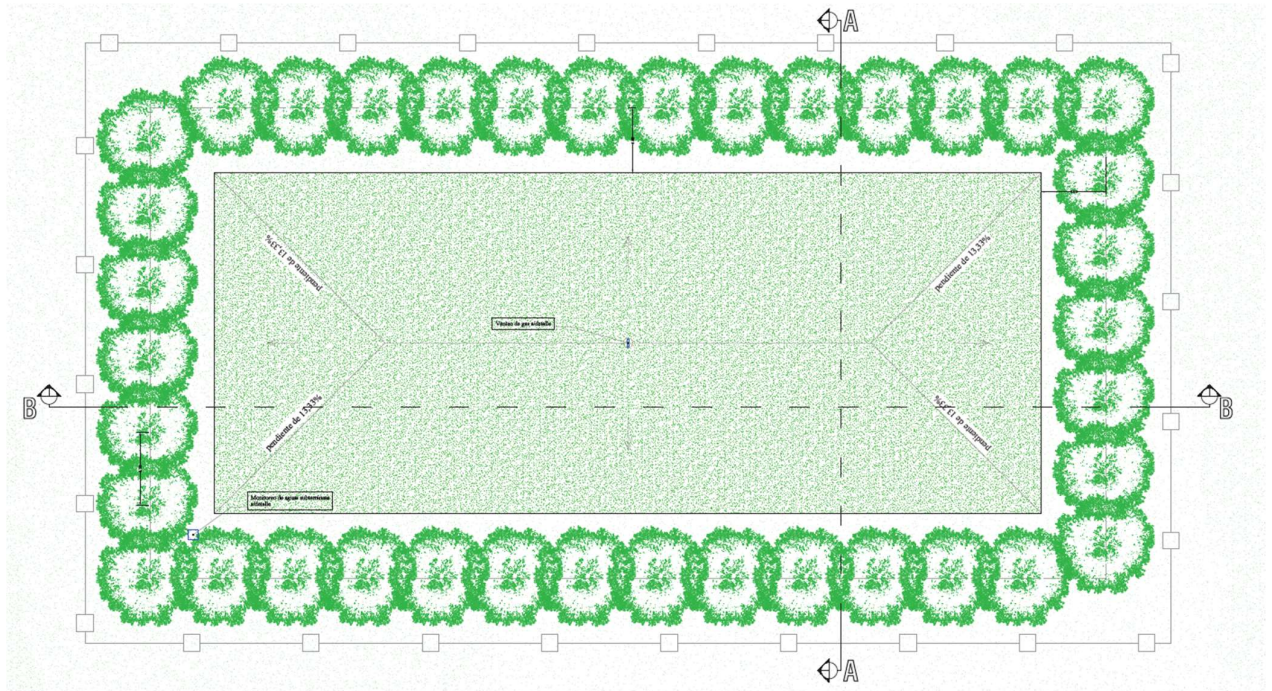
| Planta terminada de la trinchera de cierre. Elaboración propia
